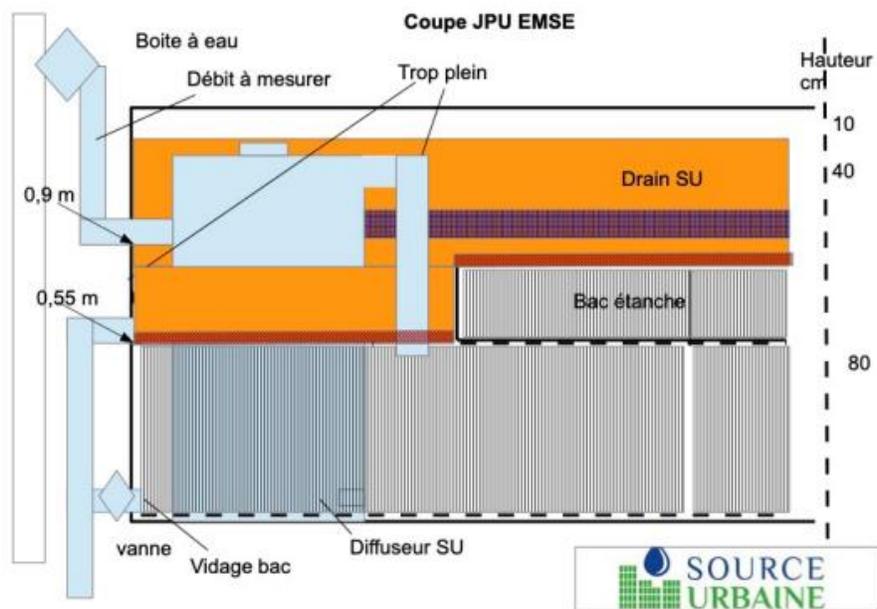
Plan en coupe du JPU (élaboré par l'entreprise SOURCE URBAINE)
